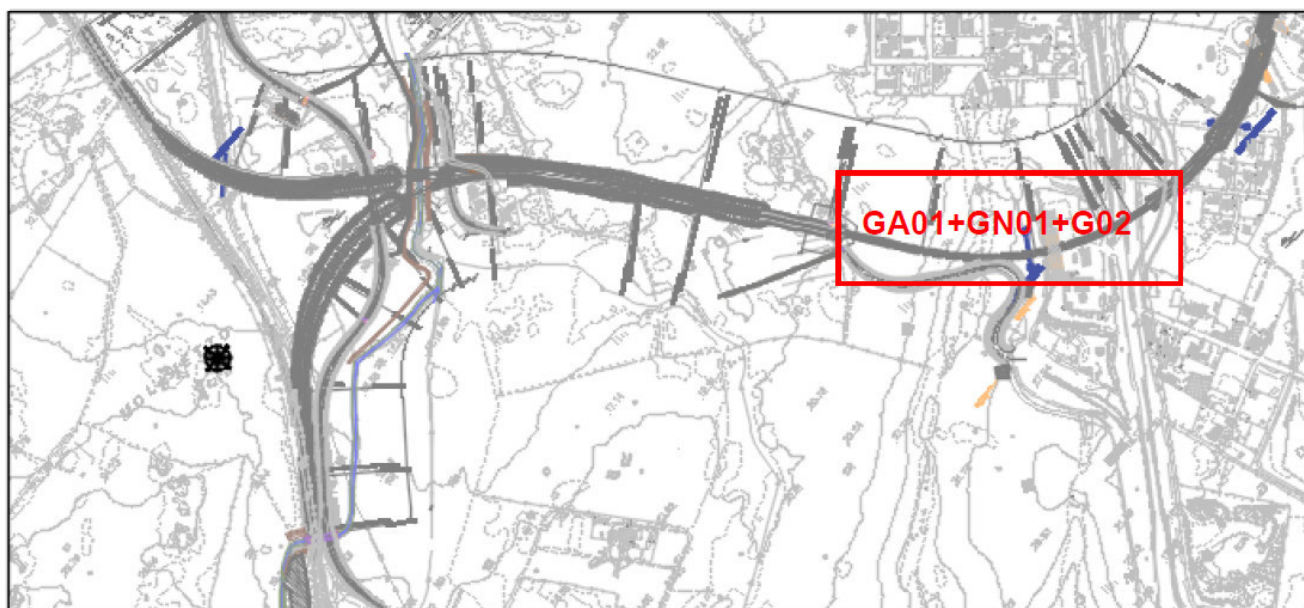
Planimetria di progetto GA01+GN02+GA02
